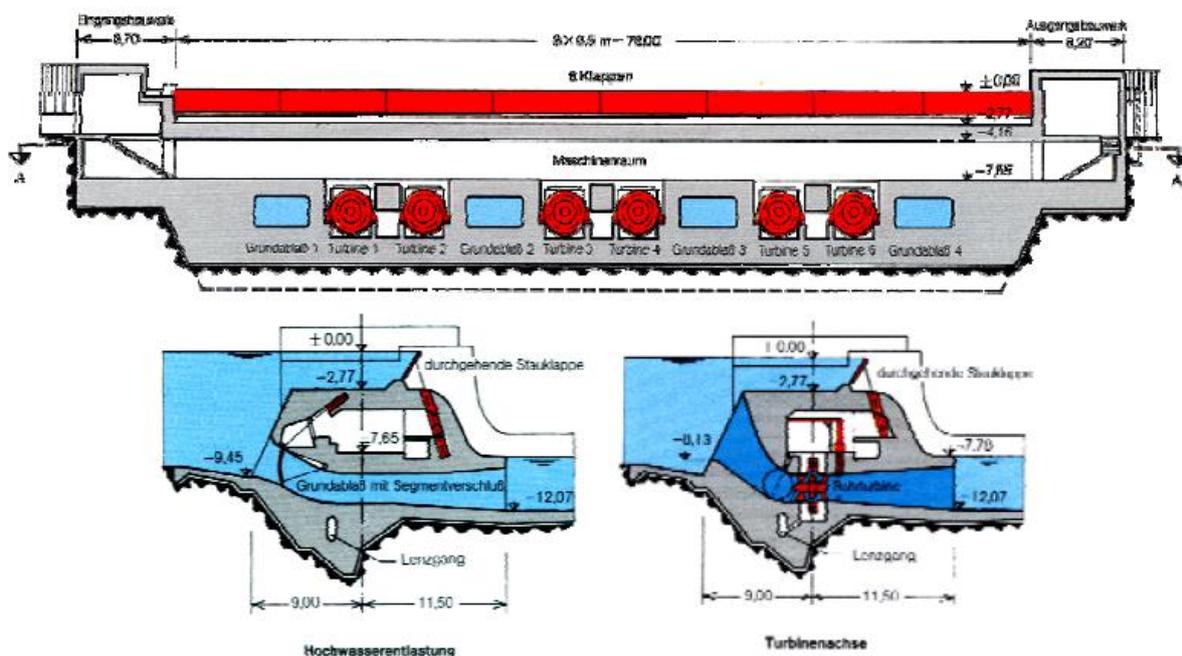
Überströmbares Kraftwerk (Quelle: Wasserbau FS 10)
